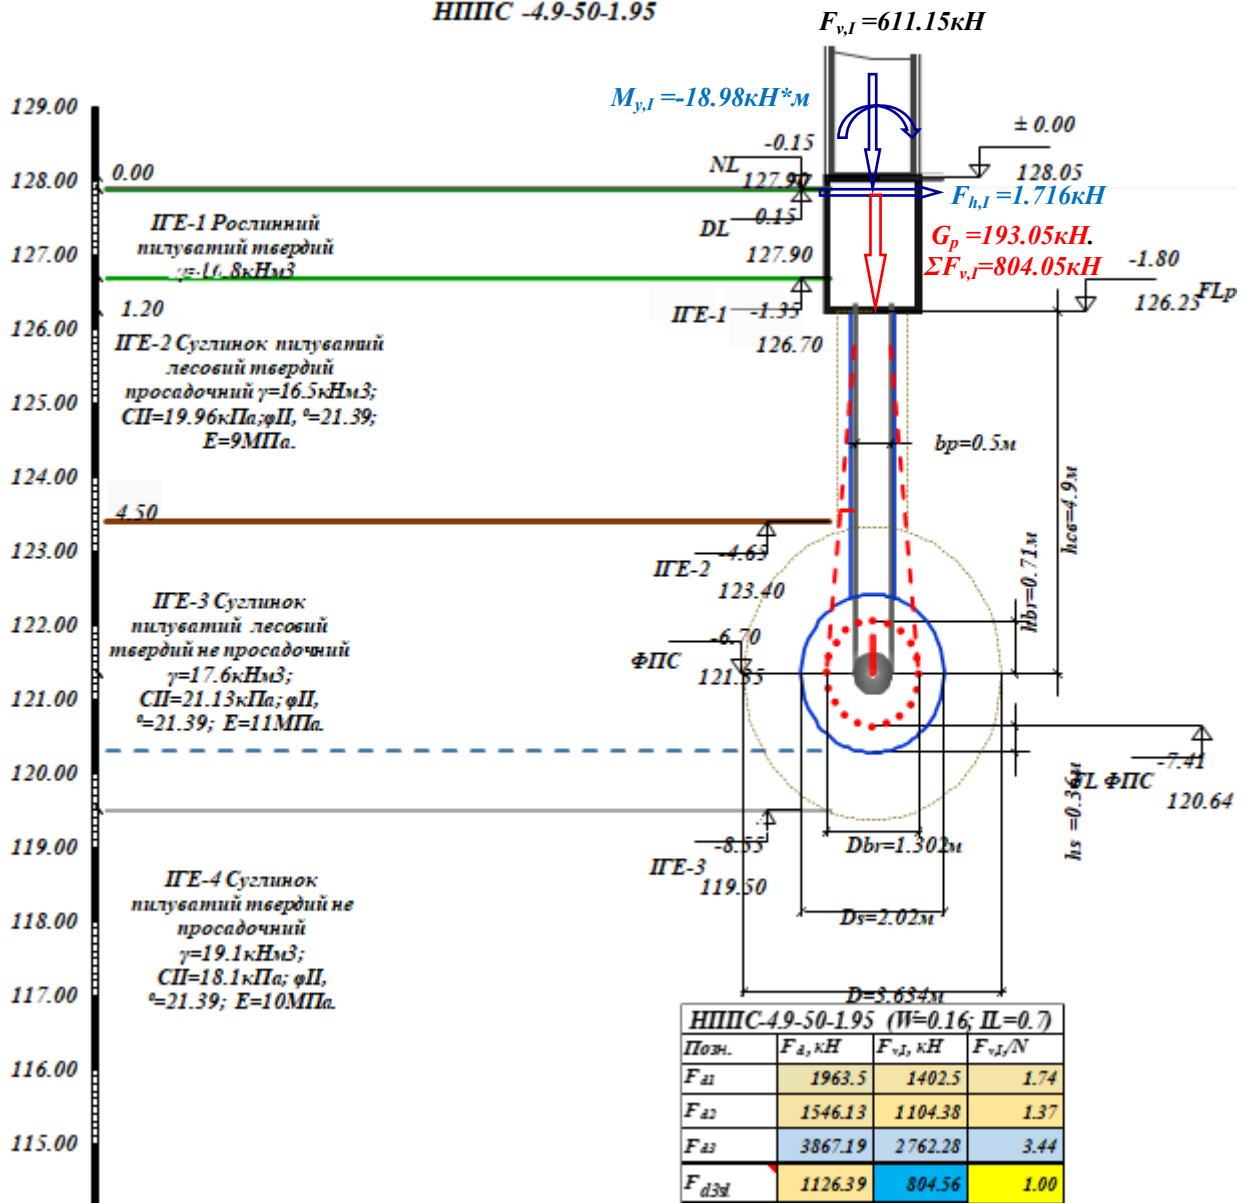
Фундамент з НППС-4.9-50-1.95 під колони вздовж осей Б і В.
